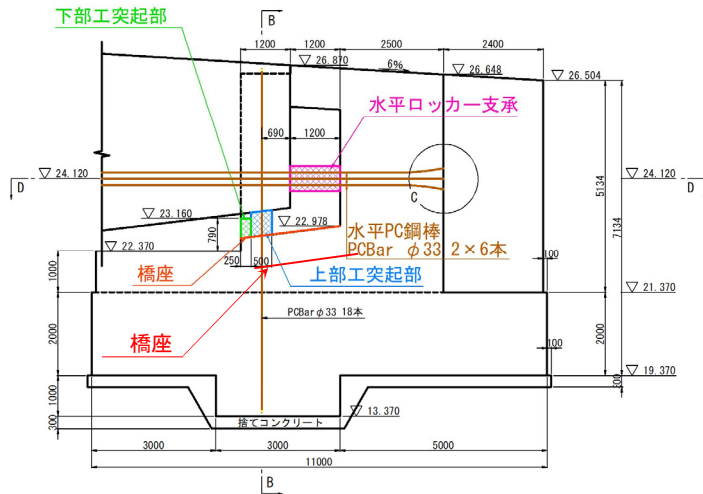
橋台 PC 鋼棒配置図 (竣工当時の図面より)
